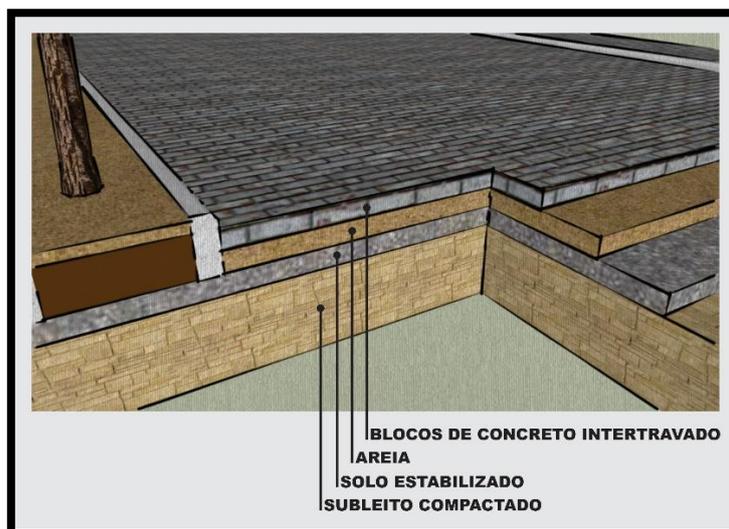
Pavimentação propostas para ruas locais. Fonte: elaborada pelo autor.
